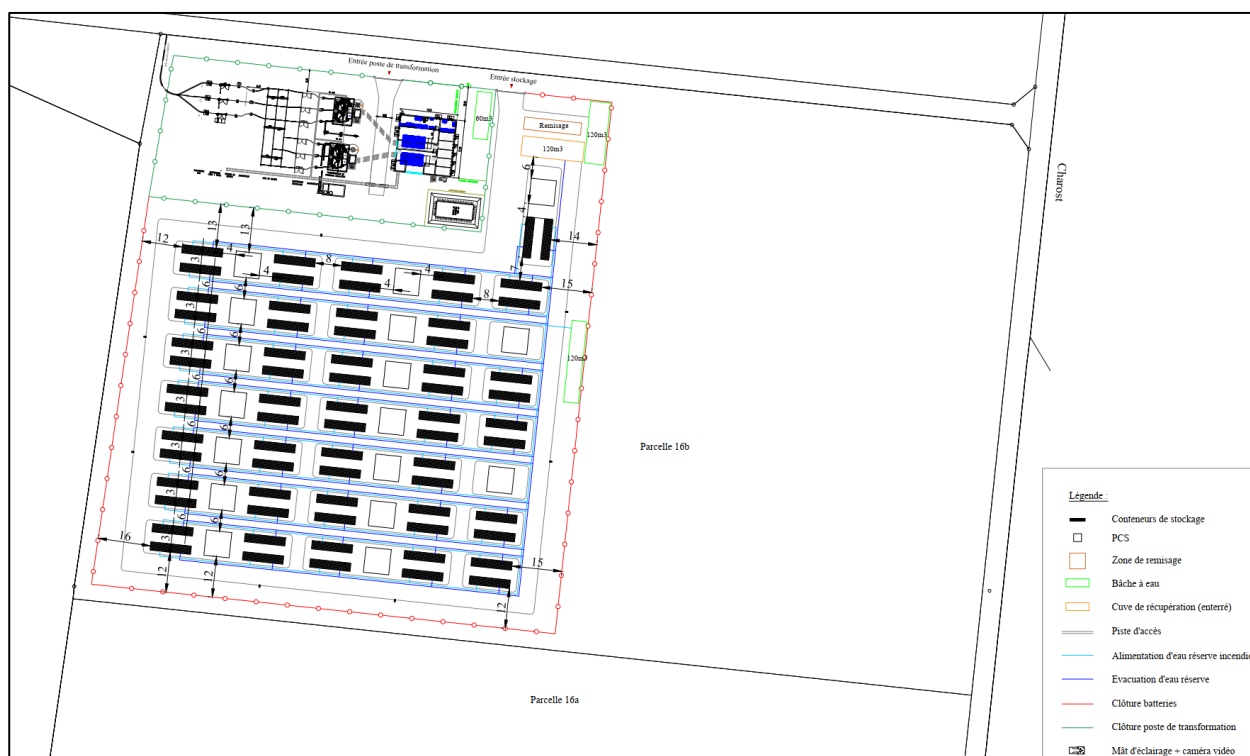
Plan de masse du projet situé à Sainte-Lizaigne
